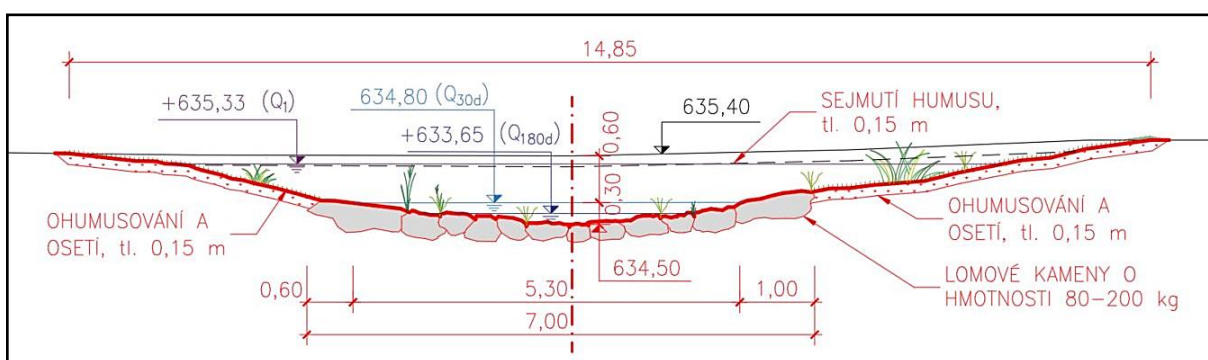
Detail příčného profilu s rybím úkrytem – Detail A, příloha C.10.
